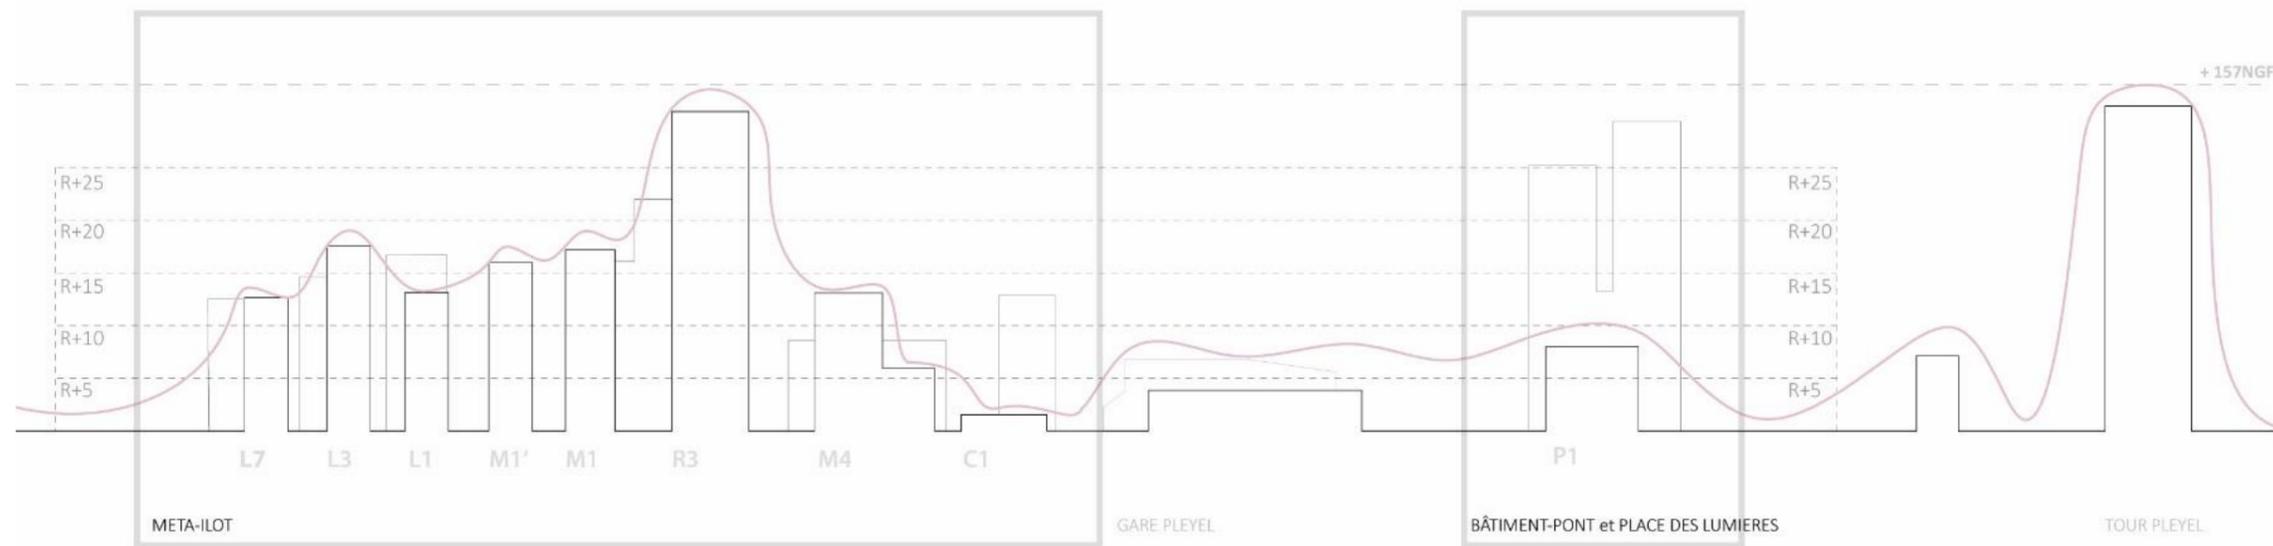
schéma des hauteurs relatives des constructions les unes par rapport aux autres dans le sous-secteur du Méta-îlot (*Emprises bâties indicatives*)
